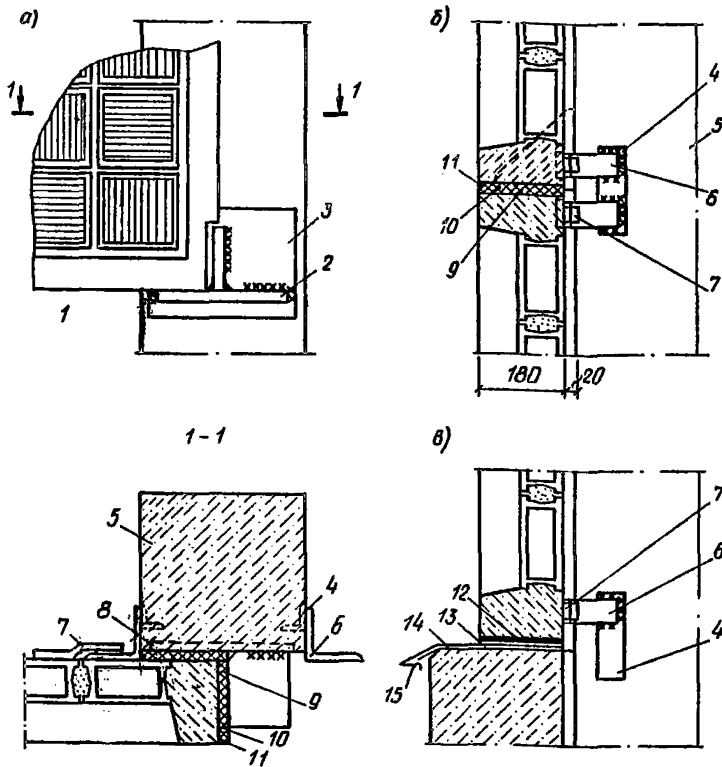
Узлы вертикального стекложелезобетонного ограждения
